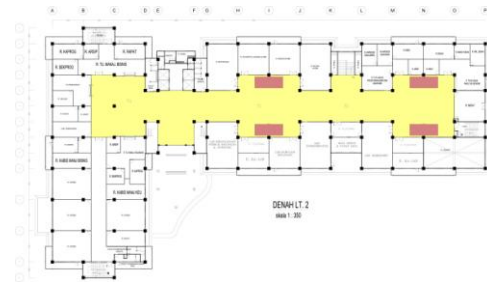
Alternatif area *study pod* gedung P lantai 2.
